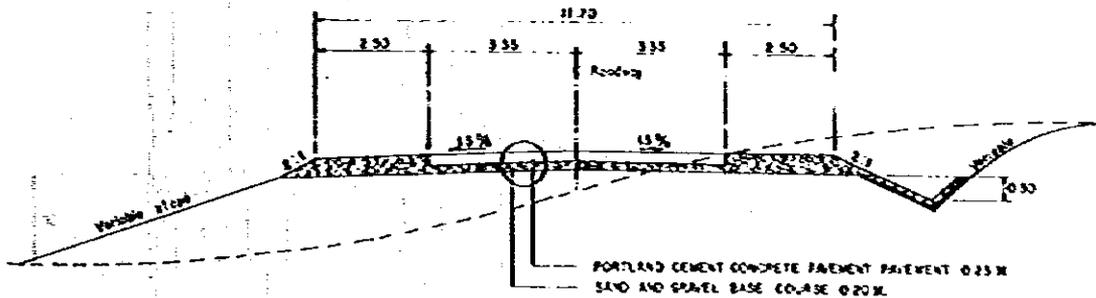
1(a) 標準横断面 (平地及び丘陵部)
